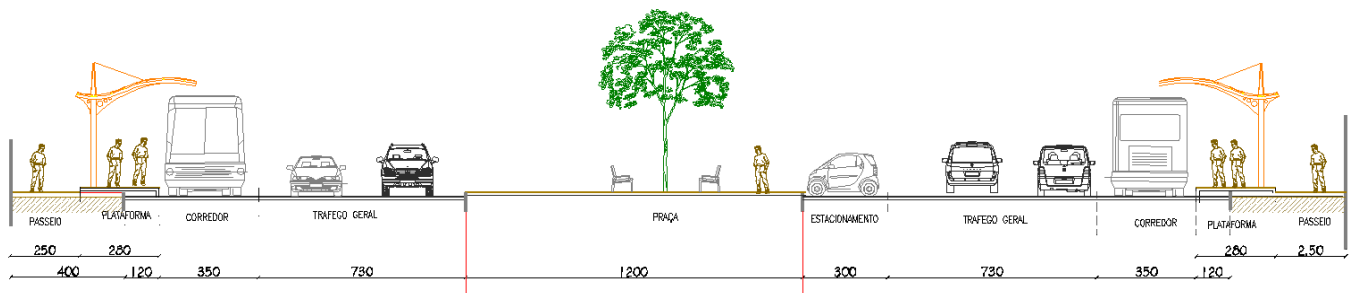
Perfil transversal da Av. Rio Branco com a implantação das plataformas
